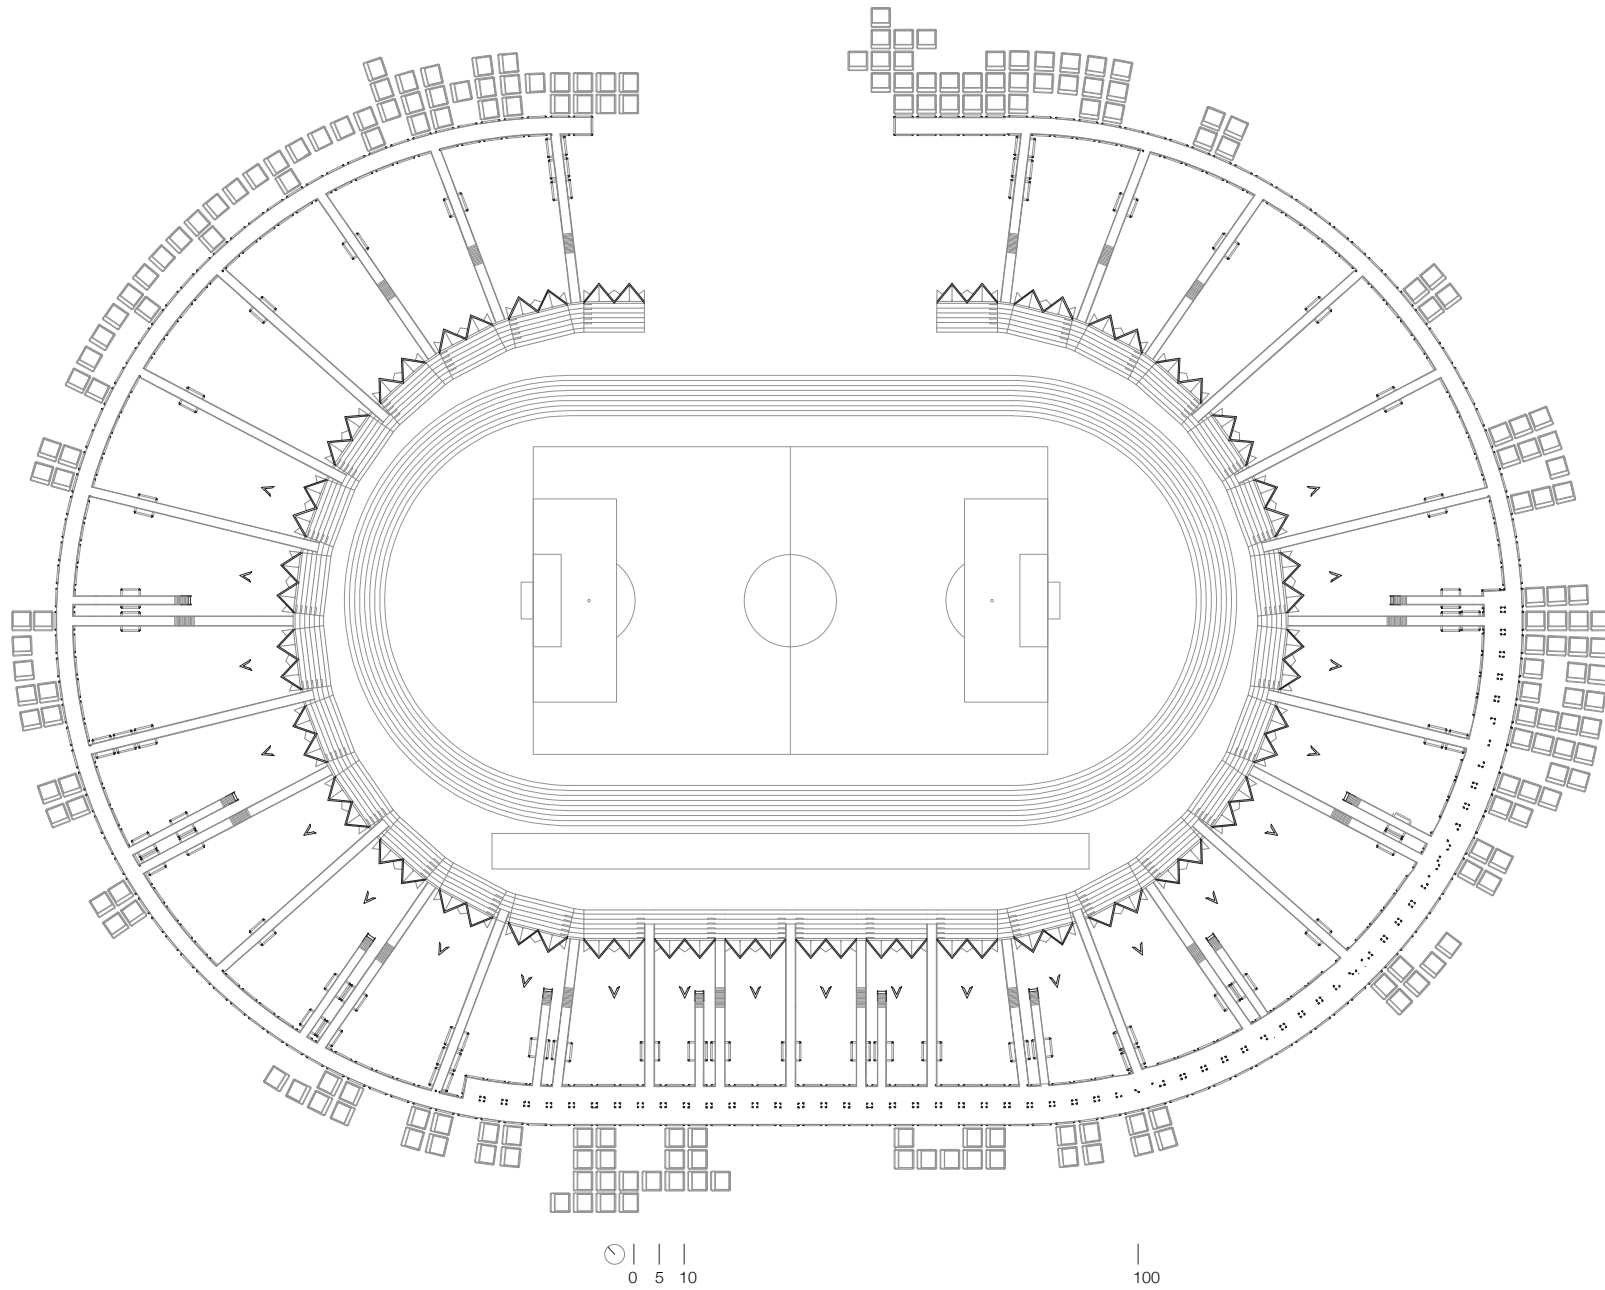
Planta +5.00 m. Pasarelas circulación.
